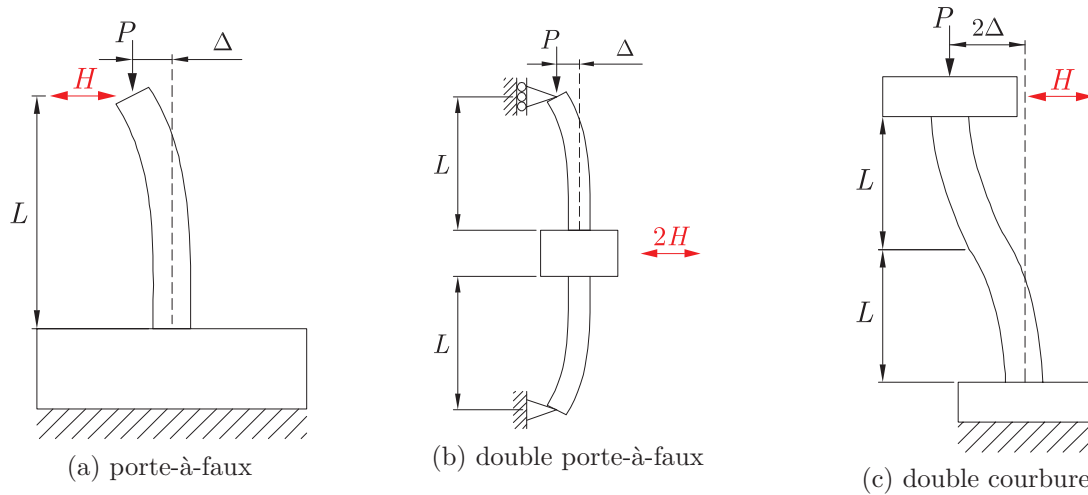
Types des spécimens pour essais cycliques des poteaux en béton armé.
